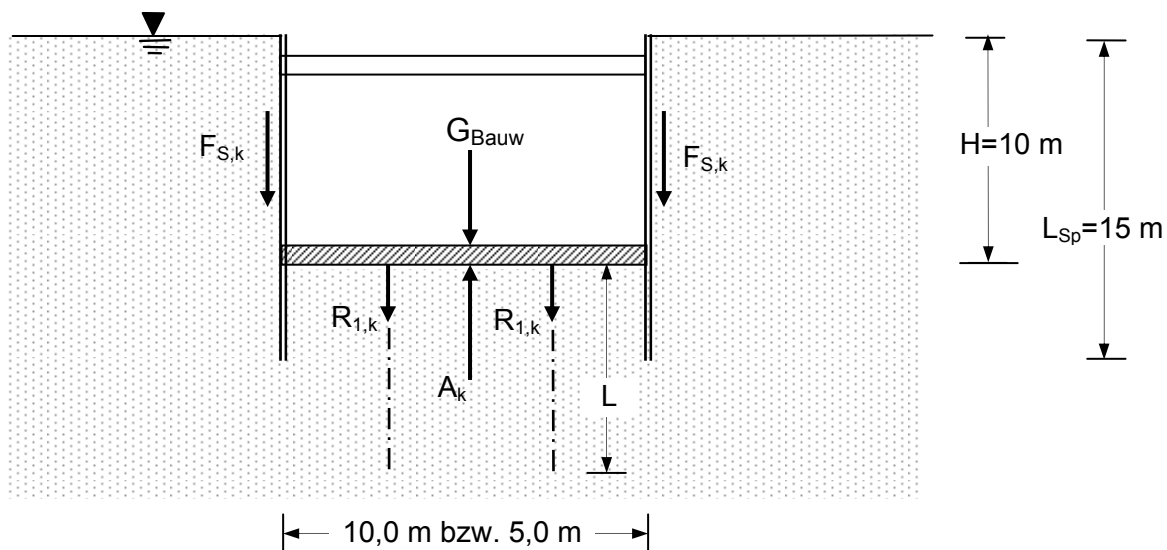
Baugrube mit Abmessungen und Einwirkungen
